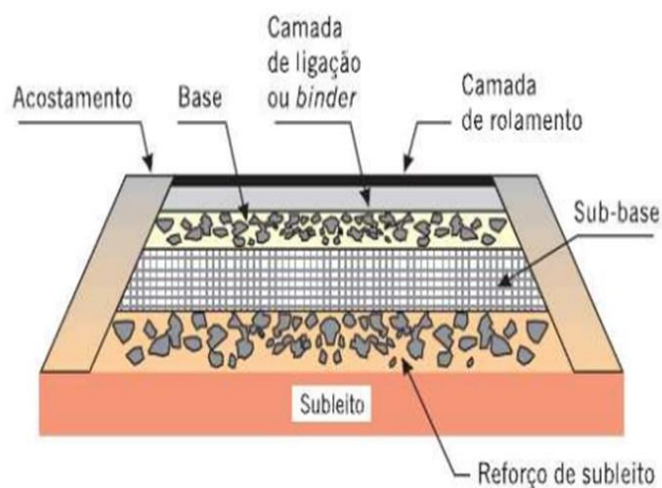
Corte transversal de um Pavimento Flexível e suas camadas subjacentes.
